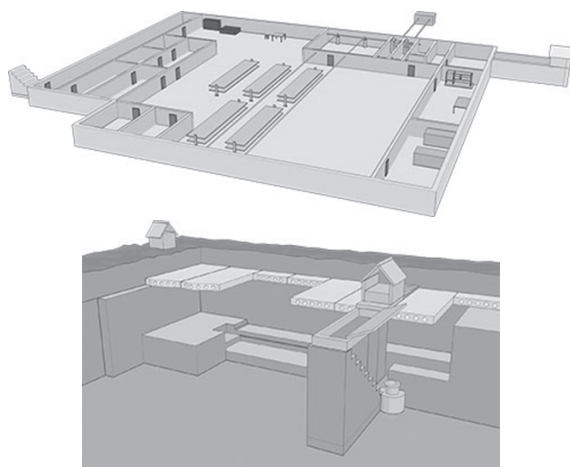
Заблаговременно возведенное убежище и быстровозводимое ПРУ из железобетонных плит
